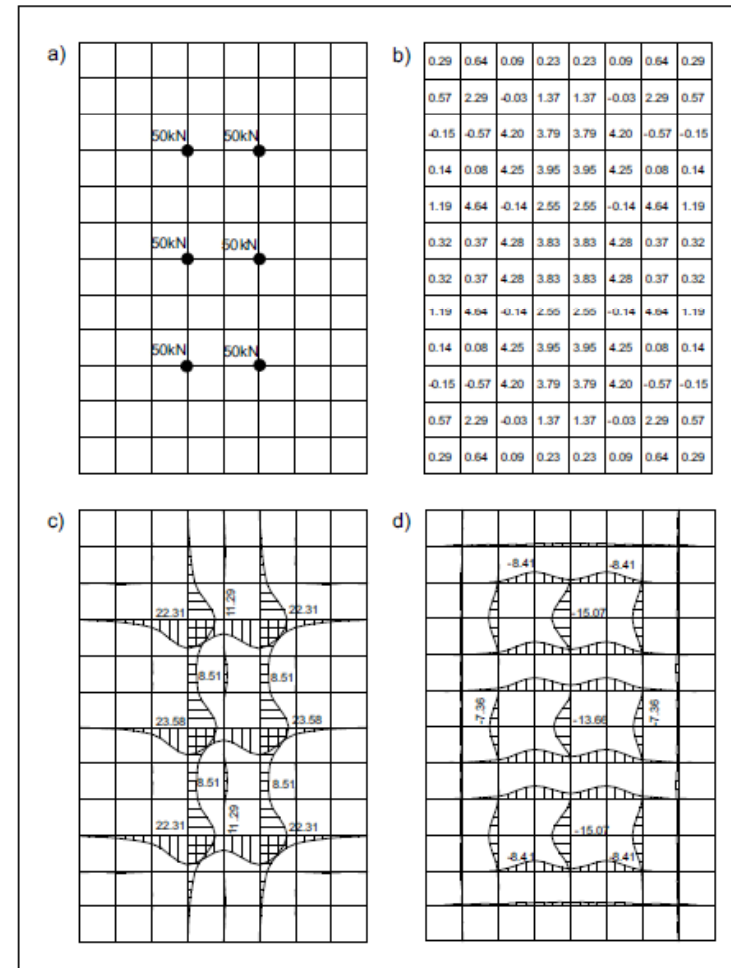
Beispiel gelenkig gelagerte Platte: a) Lastfall SLW 30, b) FE-Lastfall, Elementlasten, c) Kirchhoffschub (positiv), d) Kirchhoffschub (negativ)
